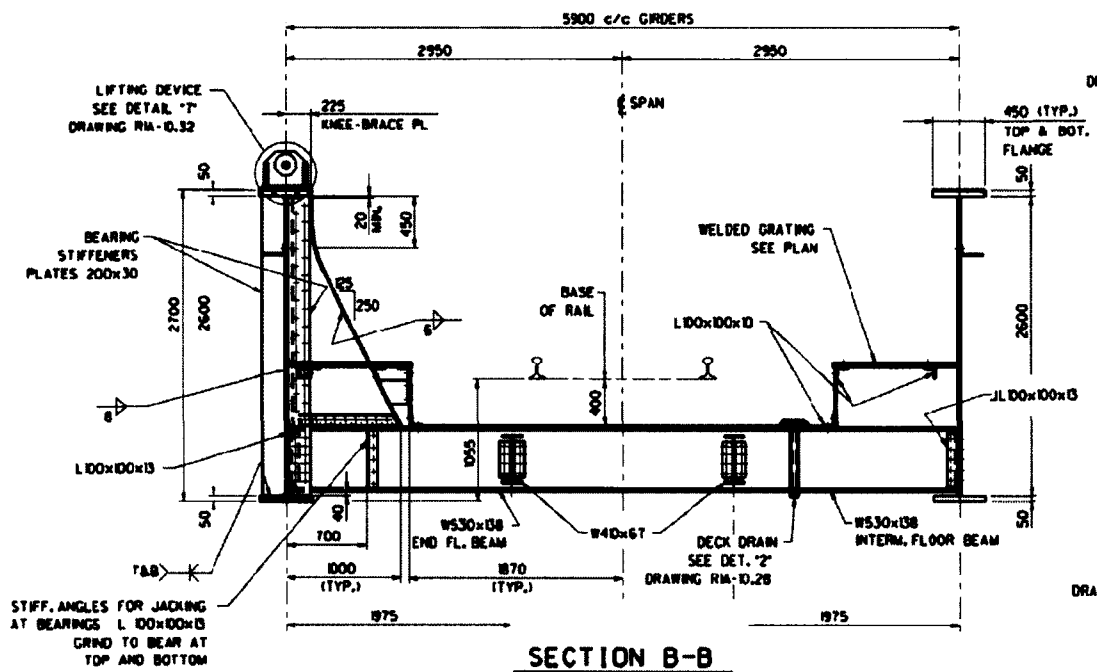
Section transversale d'un pont à poutres latérales de 25,15m [CN dessin R1A-10.27]
